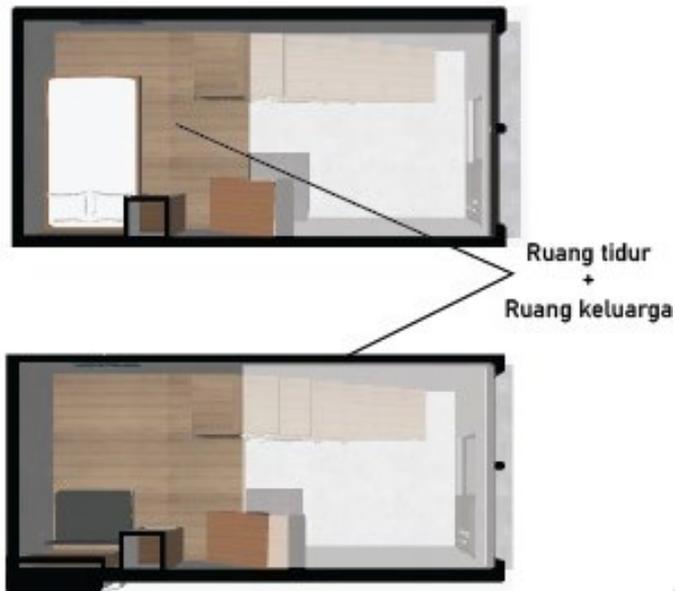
Ruang Hunian Lantai 2 Tipe 1
